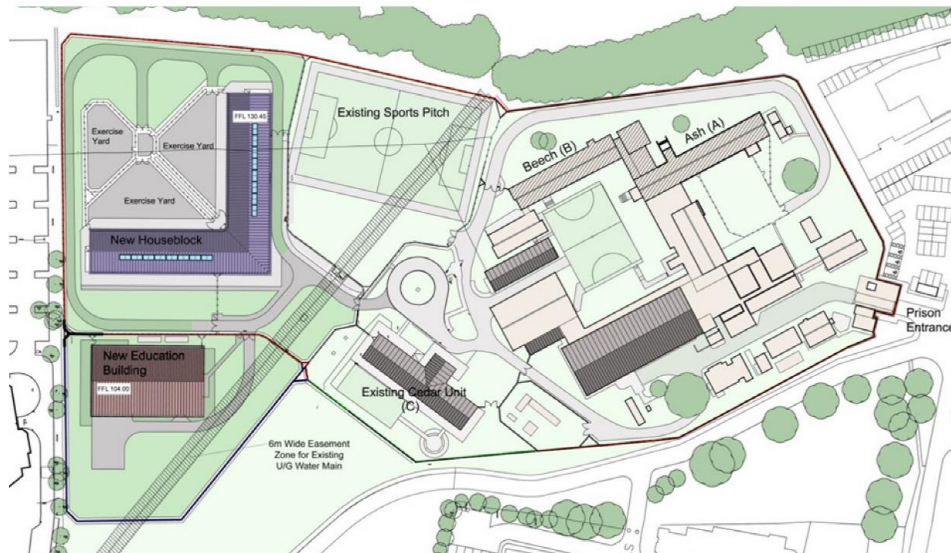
Planta de la prisión de Cookham Wood y los edificios de nueva construcción denominados New Houseblock y New Education Building (BIM Task Group, 2013a, p.6)
